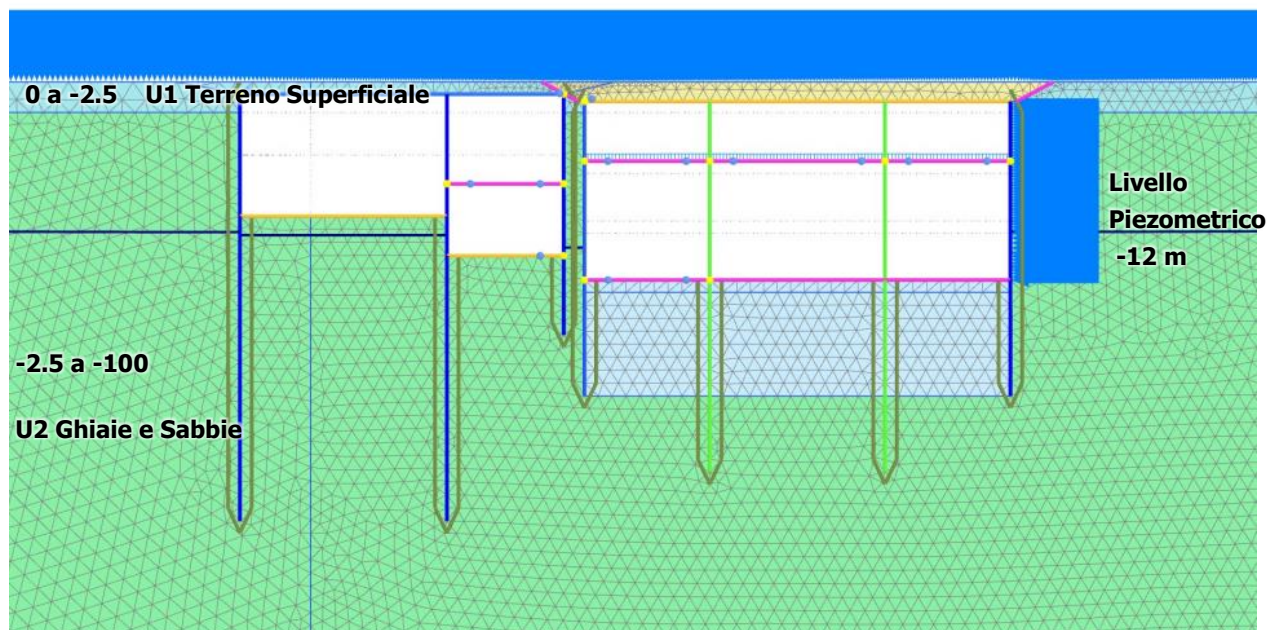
Sezione di calcolo- Stazione Rebaudengo
